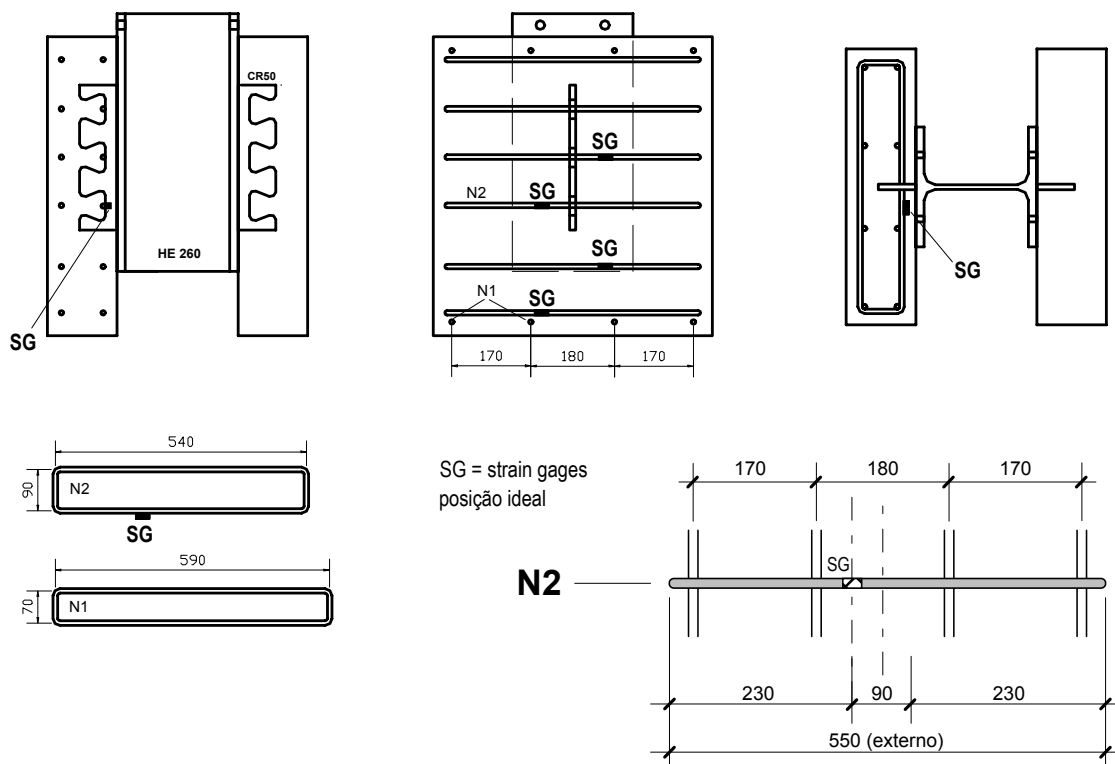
Posicionamento dos extensômetros nas barras da armadura.
